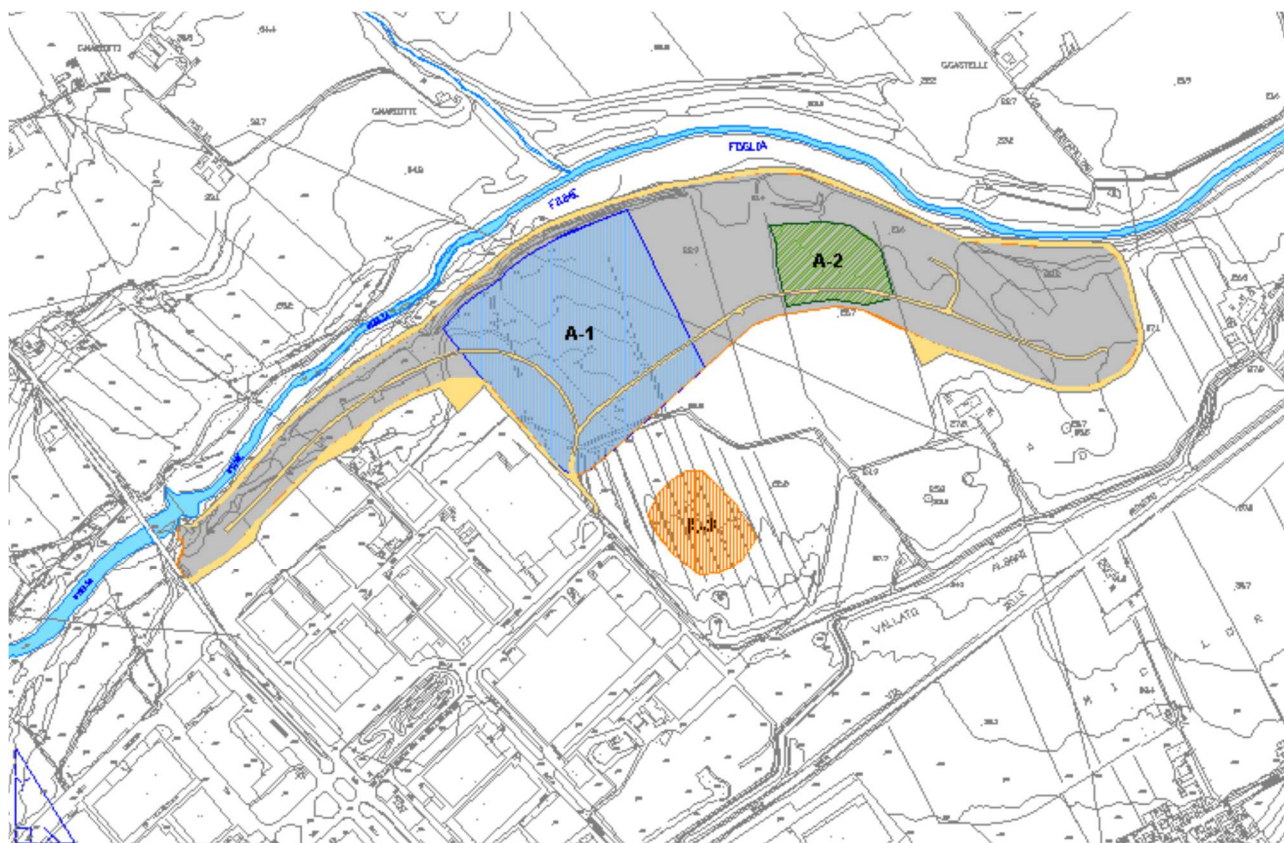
planimetria - viabilità di cantiere-aree di lavoro
